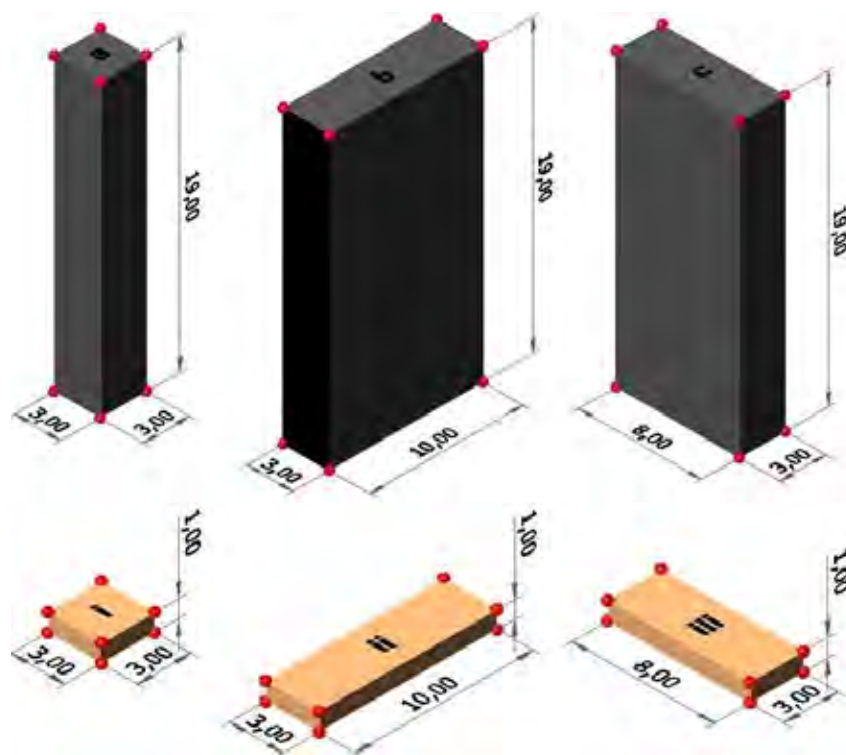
Dimensões isoladas dos elementos de bloco e de argamassa do prisma
